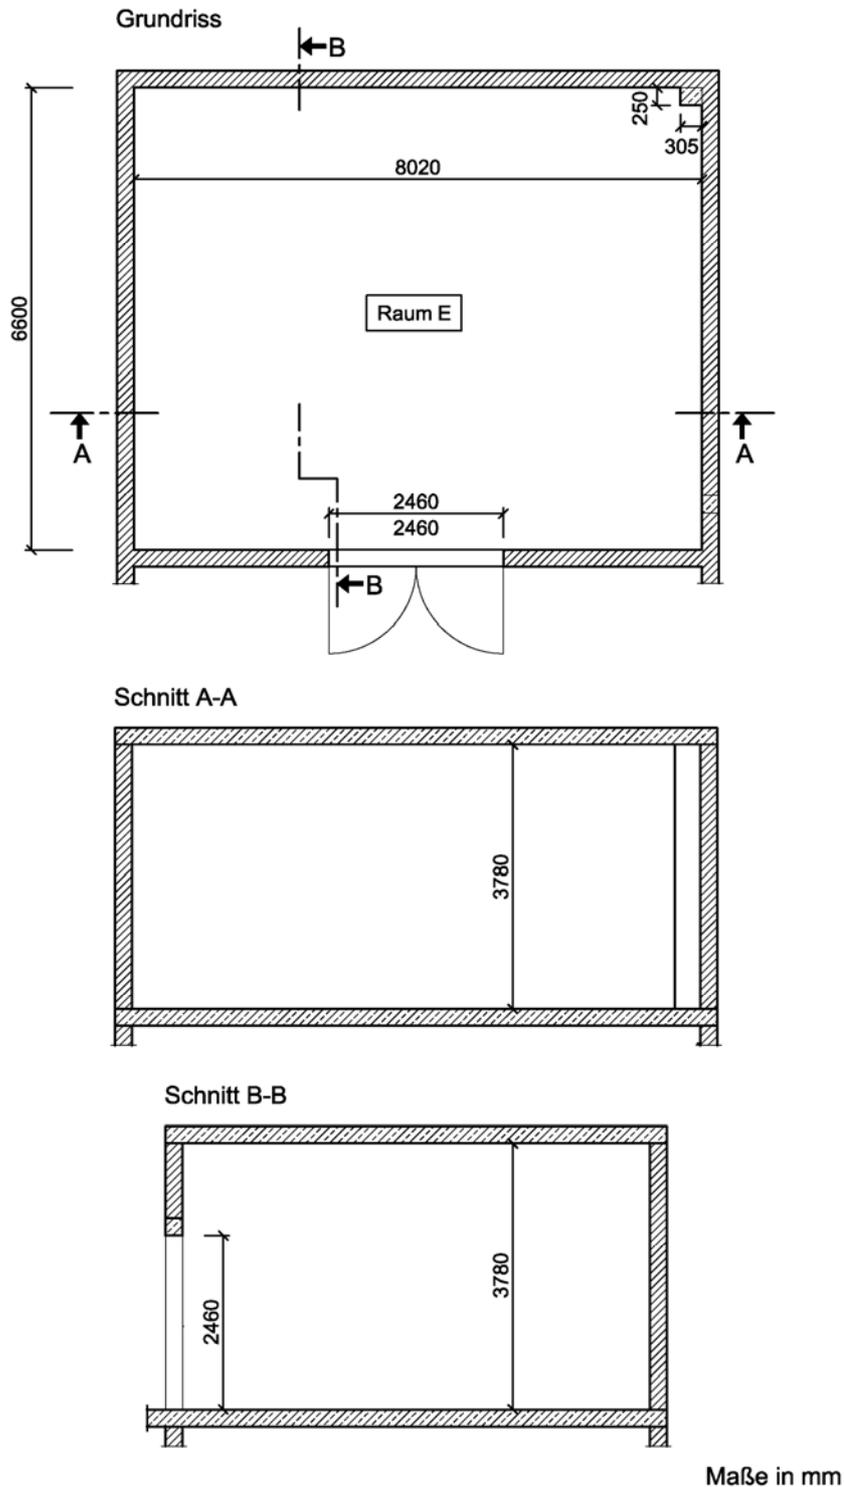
Grundriss und Schnitte des Hallraums.
